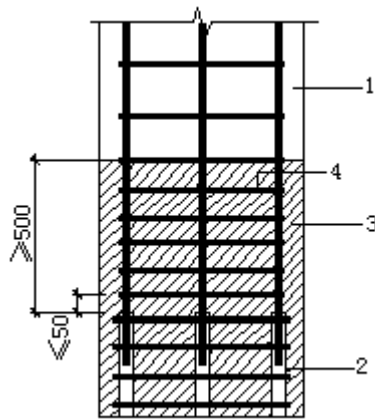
钢筋采用套筒灌浆连接时柱底箍筋加密区域构造示意
